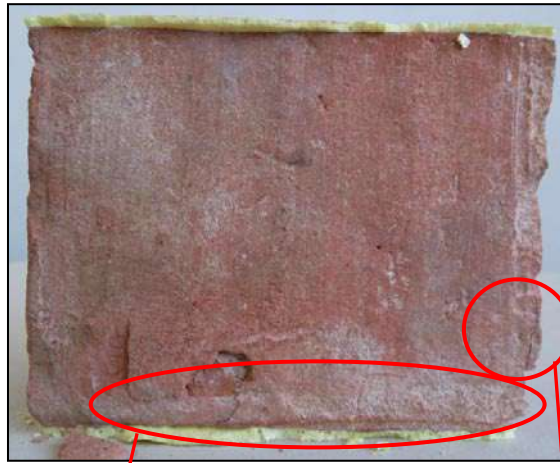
Fissures longitudinales, transversales et détachement de couche
